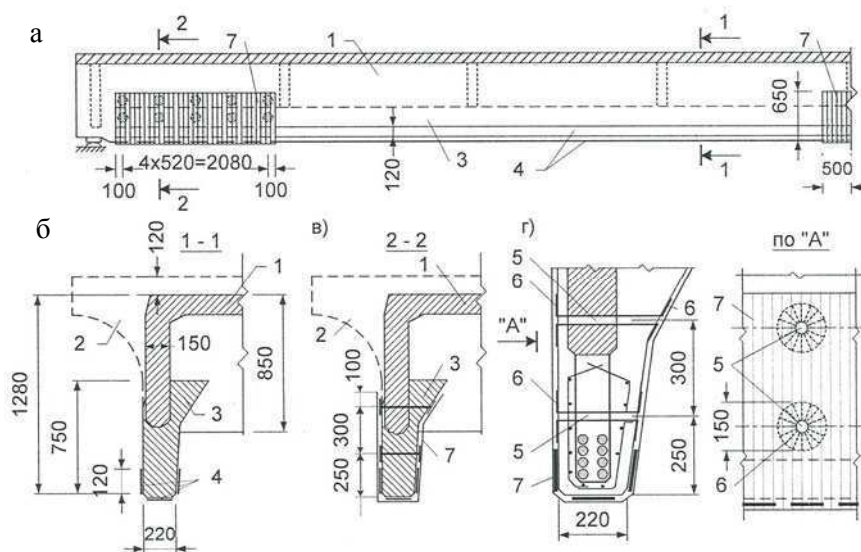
Підсилення крайніх балок довжиною 22,16 м прольотної будови шляхопроводу наклеюванням стрічок CFRP: а – загальний вигляд балки; б, в – попередні перерізи 1-1, 2-2; г – вузол анкерування стрічок підсилення
